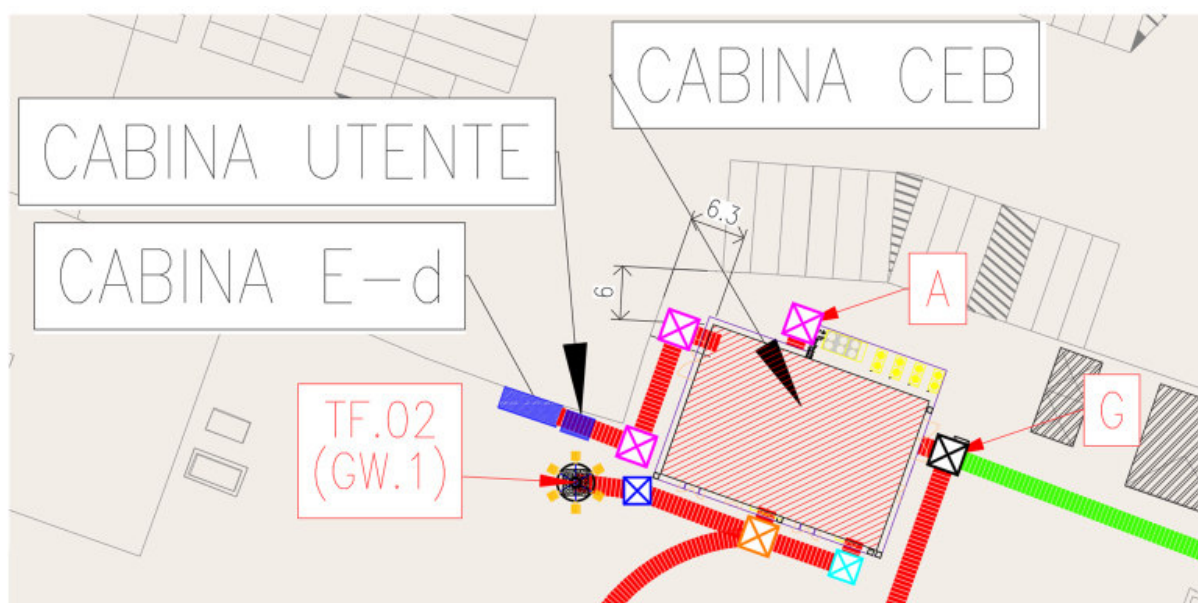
Stralcio della planimetria di progetto (elaborato 32016019PE0GENDIS03)
